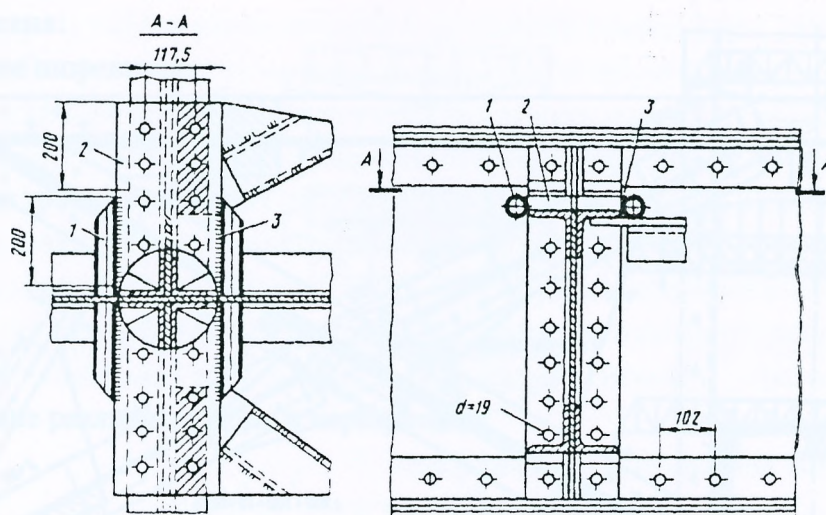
Усиление прикрепления продольных балок к поперечным: 1 – «рыбка», 2 – накладка; 3 – сварной шов.
